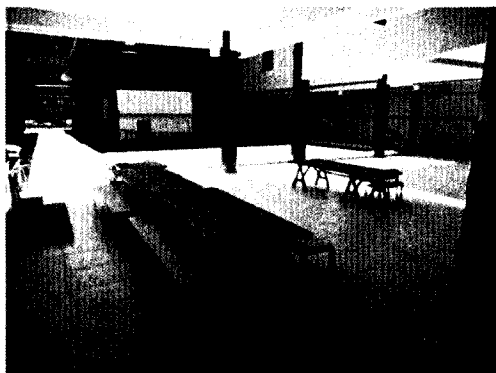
Pátio coberto, pavimento térreo, com reforma do piso, paredes e instalações.
